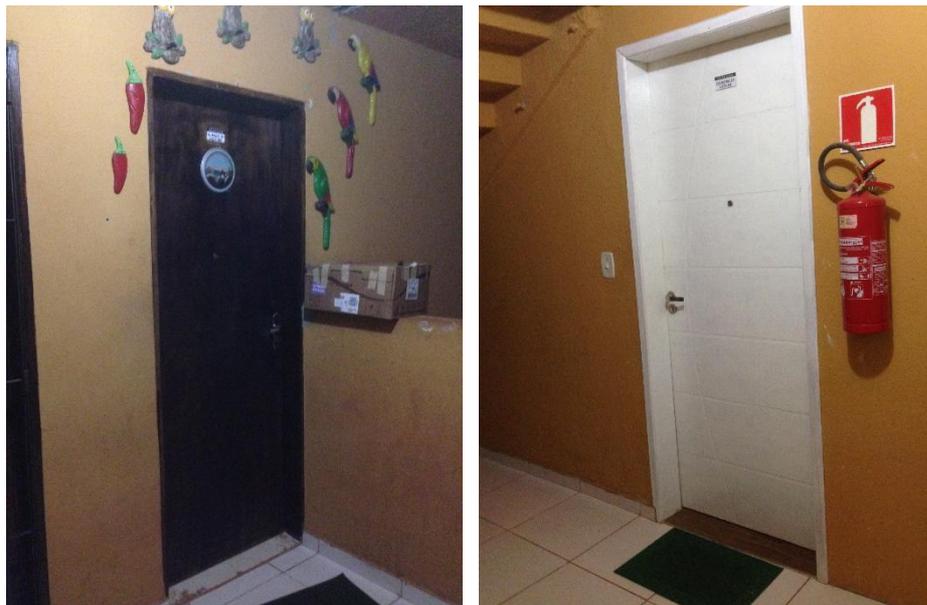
Porta de entrada, apartamento no Ribeira 8.
